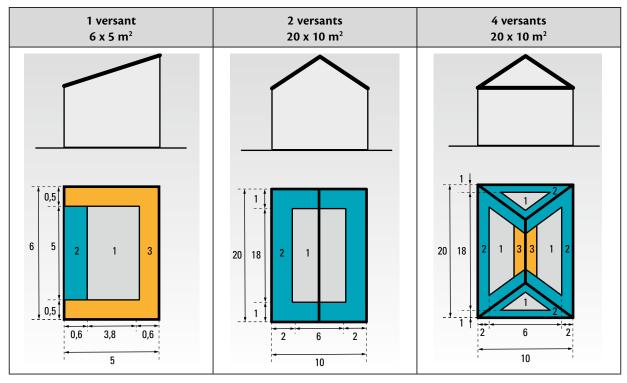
Exemples de dimensions des zones de toiture selon le nombre de versants (projection sur le plan horizontal et non pas sur le plan des versants)
